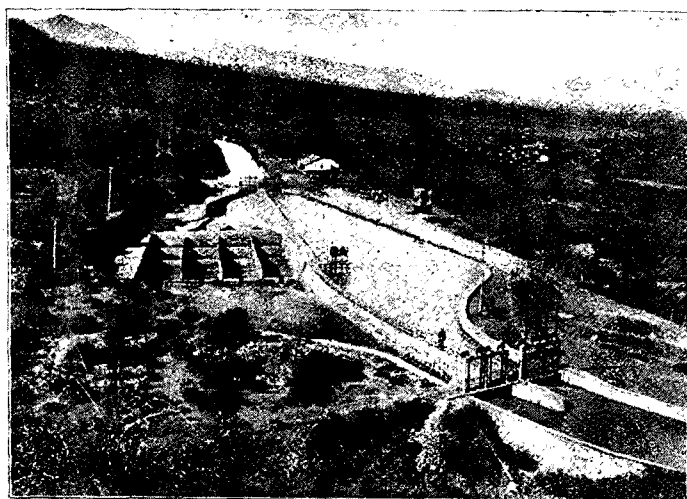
Vue prise en 1913 après la construction du nouveau dessableur dans le bassin de droite
